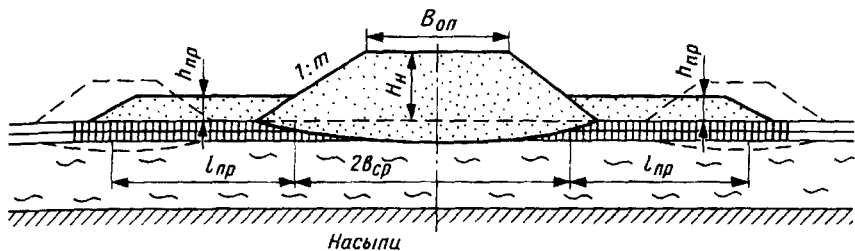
Расчетный поперечник с пригрузочными бермами
